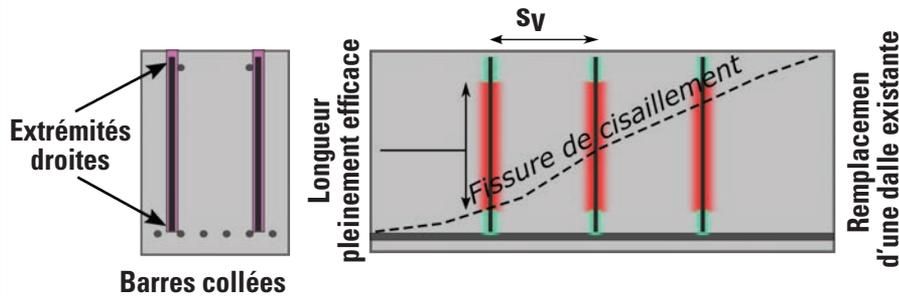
Barres collées lors du renforcement d'une dalle existante
